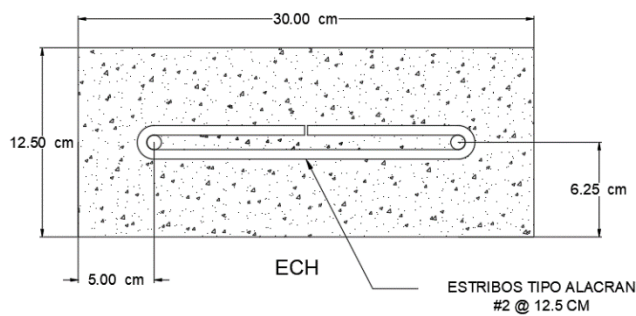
Sección Transversal elemento confinante Horizontal – Acero Transversal– Modelo III
